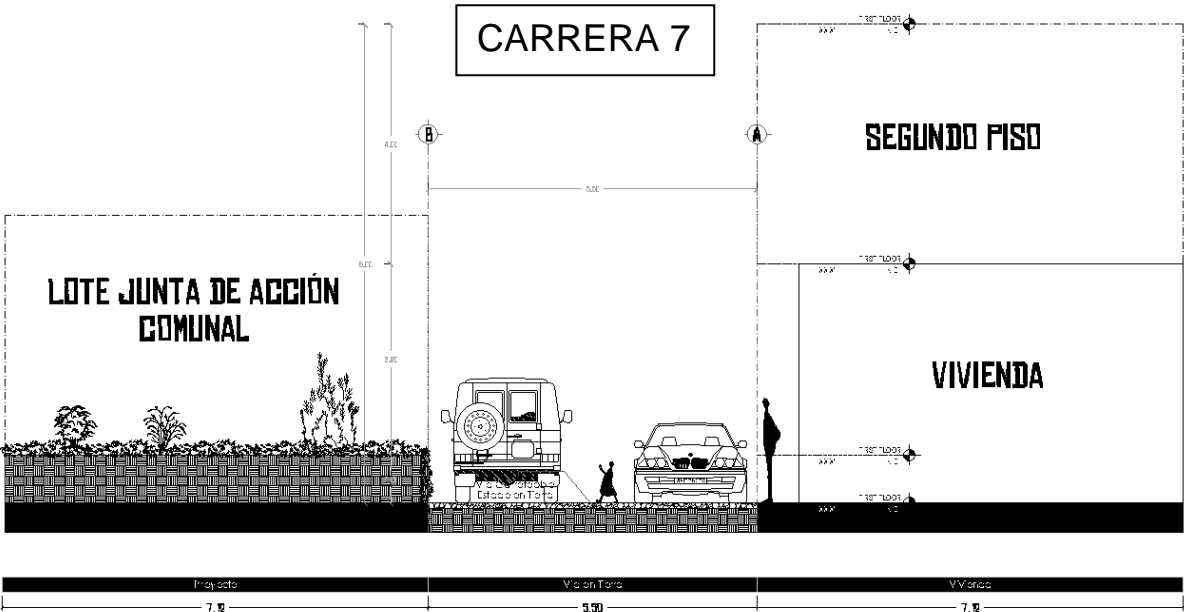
Perfil Vial - Carrera 7, Elaboración propia
